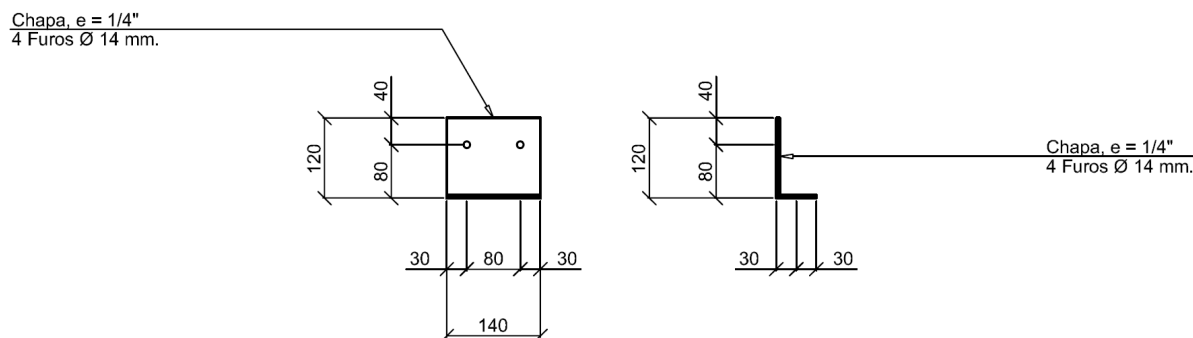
DETALHE - CHAPAS METÁLICAS DE LIGAÇÃO: COBERTURA 01
